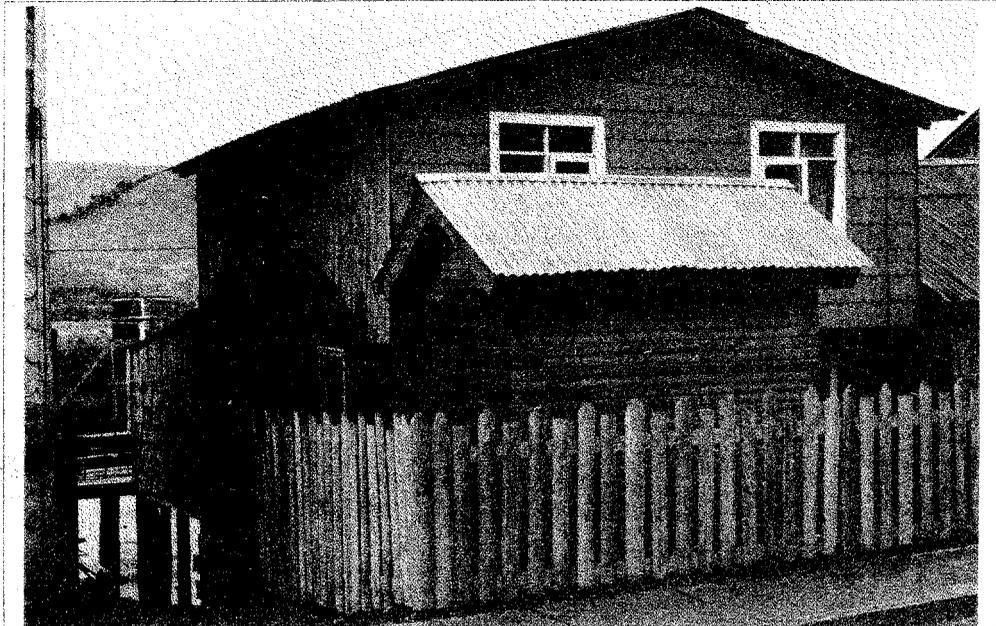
Caseta sanitaria en sistema constructivo en madera revestido con zinc. XII Región.
